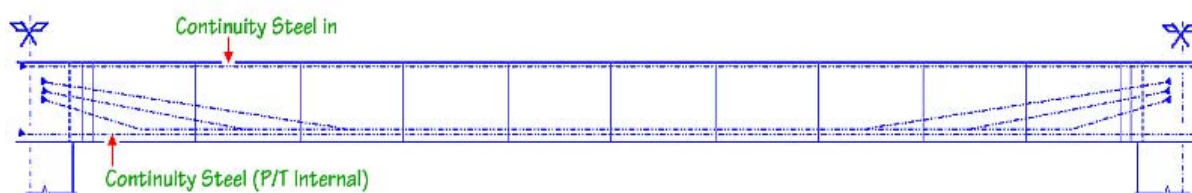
Traçado do pré-esforço exterior longitudinal na superestrutura.
